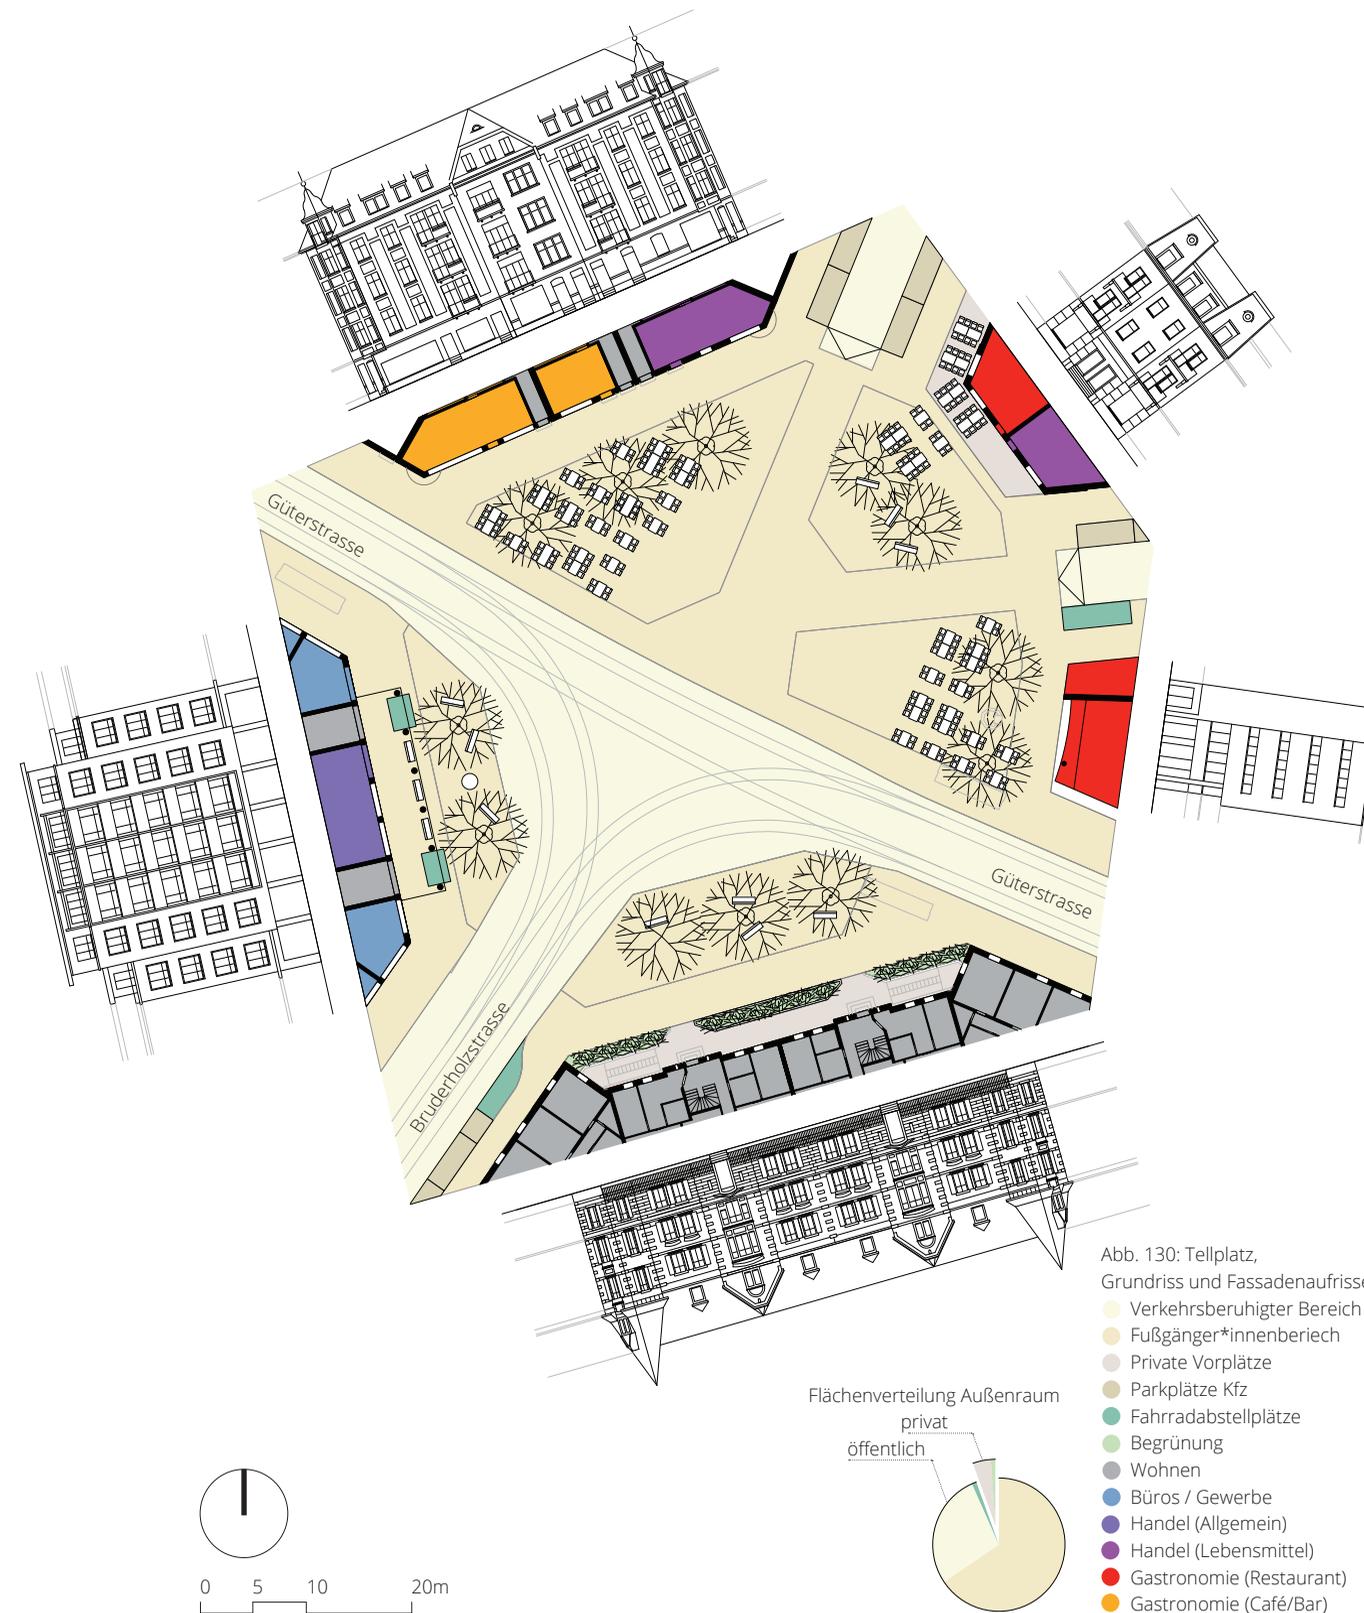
Tellplatz, Grundriss und Fassadenaufrisse
